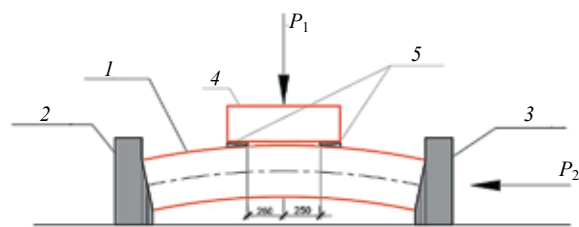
Схема расположения фрагмента тубинга и его нагружения: 1 — фрагмент тубинга; 2 — неподвижный упор; 3 — подвижный упор; 4 — траверса для передачи нагрузки; 5 — стальные пластины; P_1 — вертикальная нагрузка; P_2 — горизонтальная нагрузка
